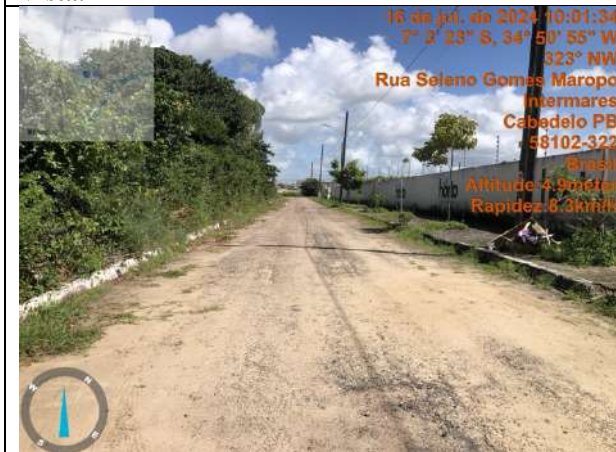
Rua Projetada II, Loteamento Bela Vista.
